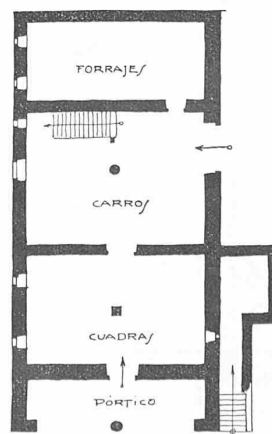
und 2. Grundrisse zum Haus Tafel 14 oben.
